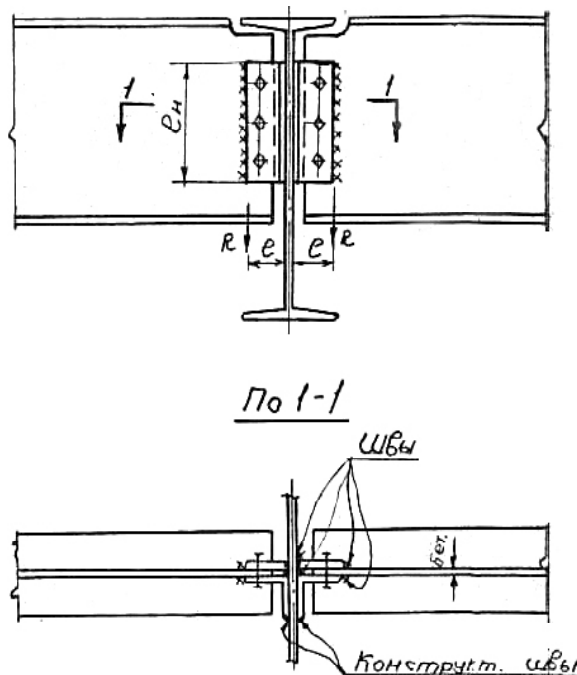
Шарнирный узел на сварке по серии 1926/66.
